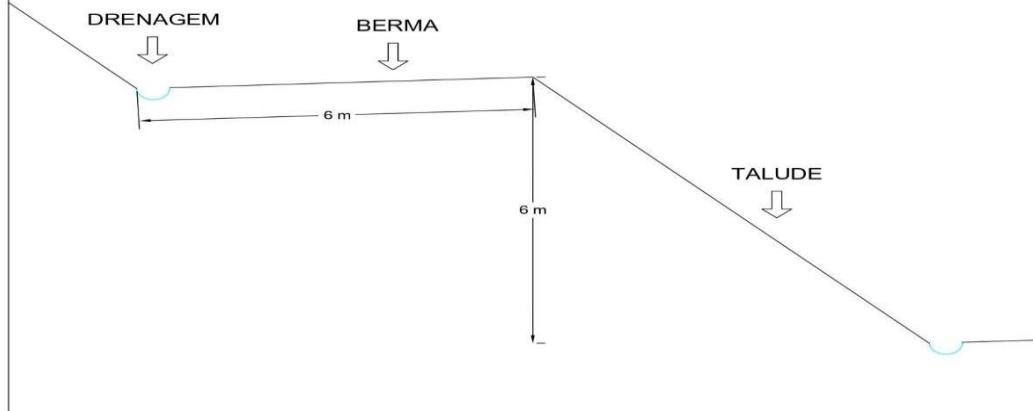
Desenho ilustrativo da drenagem da pilha, página 10, do Projeto de Pilha
